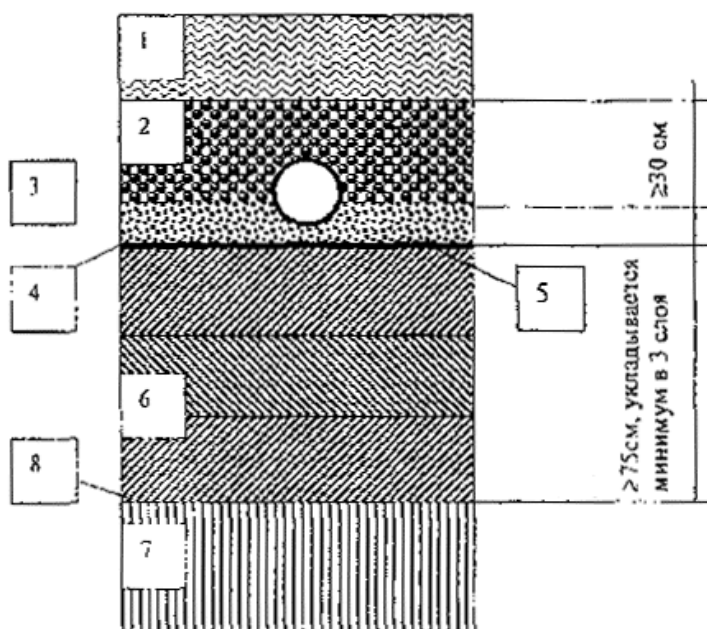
Конструкция защитного экрана основания полигона 2-го класса: 1 - свалочный грунт, 2 - дренажный слой, 3 - дренажная труба, 4 - защитный слой, 5 - синтетическая гидроизоляция, 6 - минеральный изоляционный слой, 7 - геологический барьер, 8 - планировочная отметка основания карты полигона
